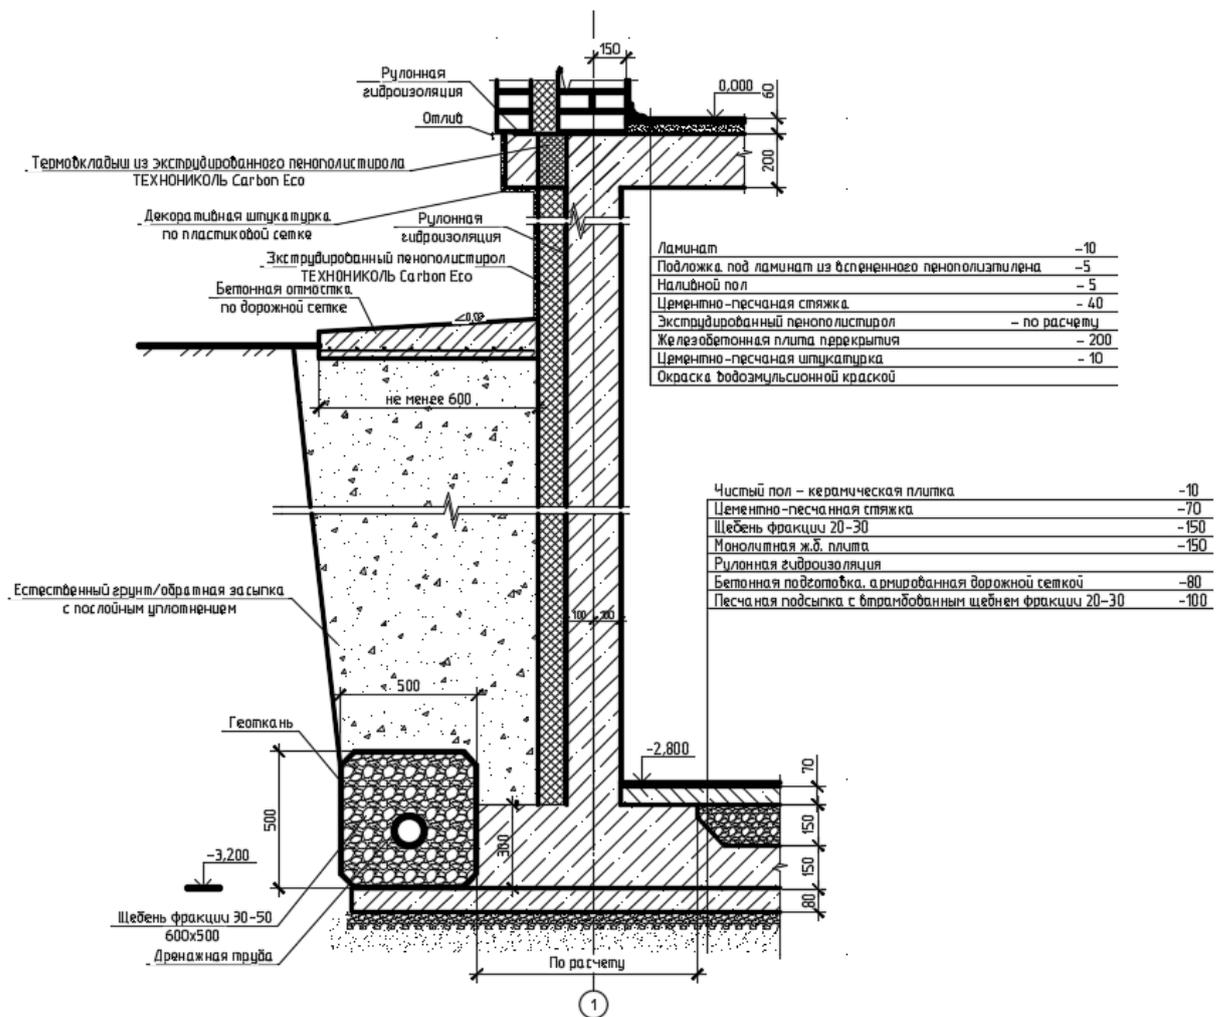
Пример выполнения конструктивных узлов ленточного фундамента для здания с подвалом
